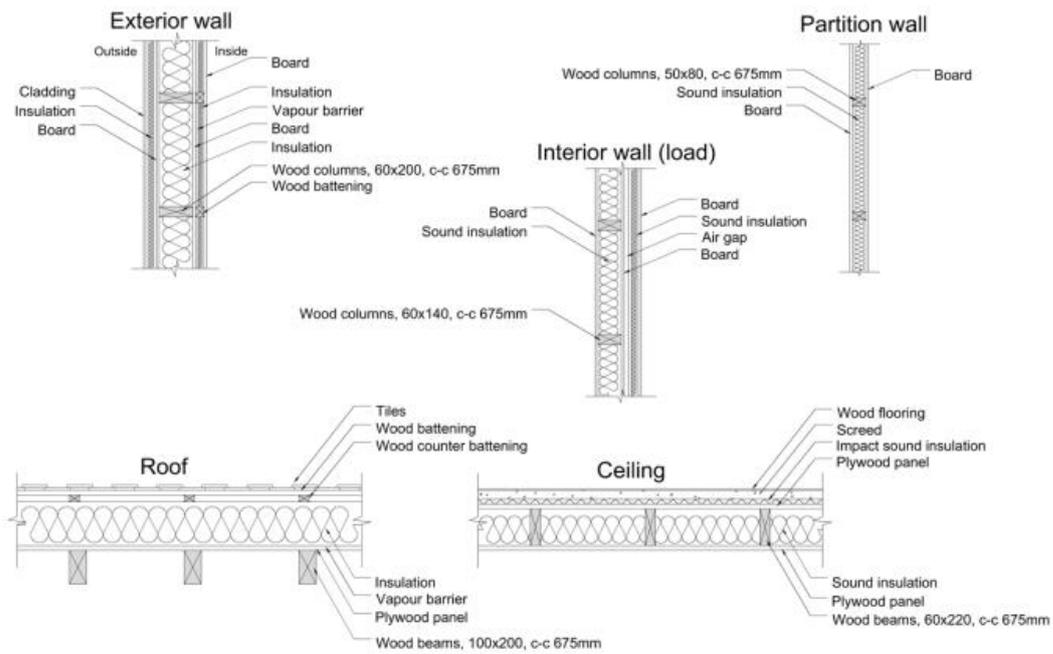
Details zu den Gebäudeelementen der Holzrahmenbauvariante des Testgebäudes.
